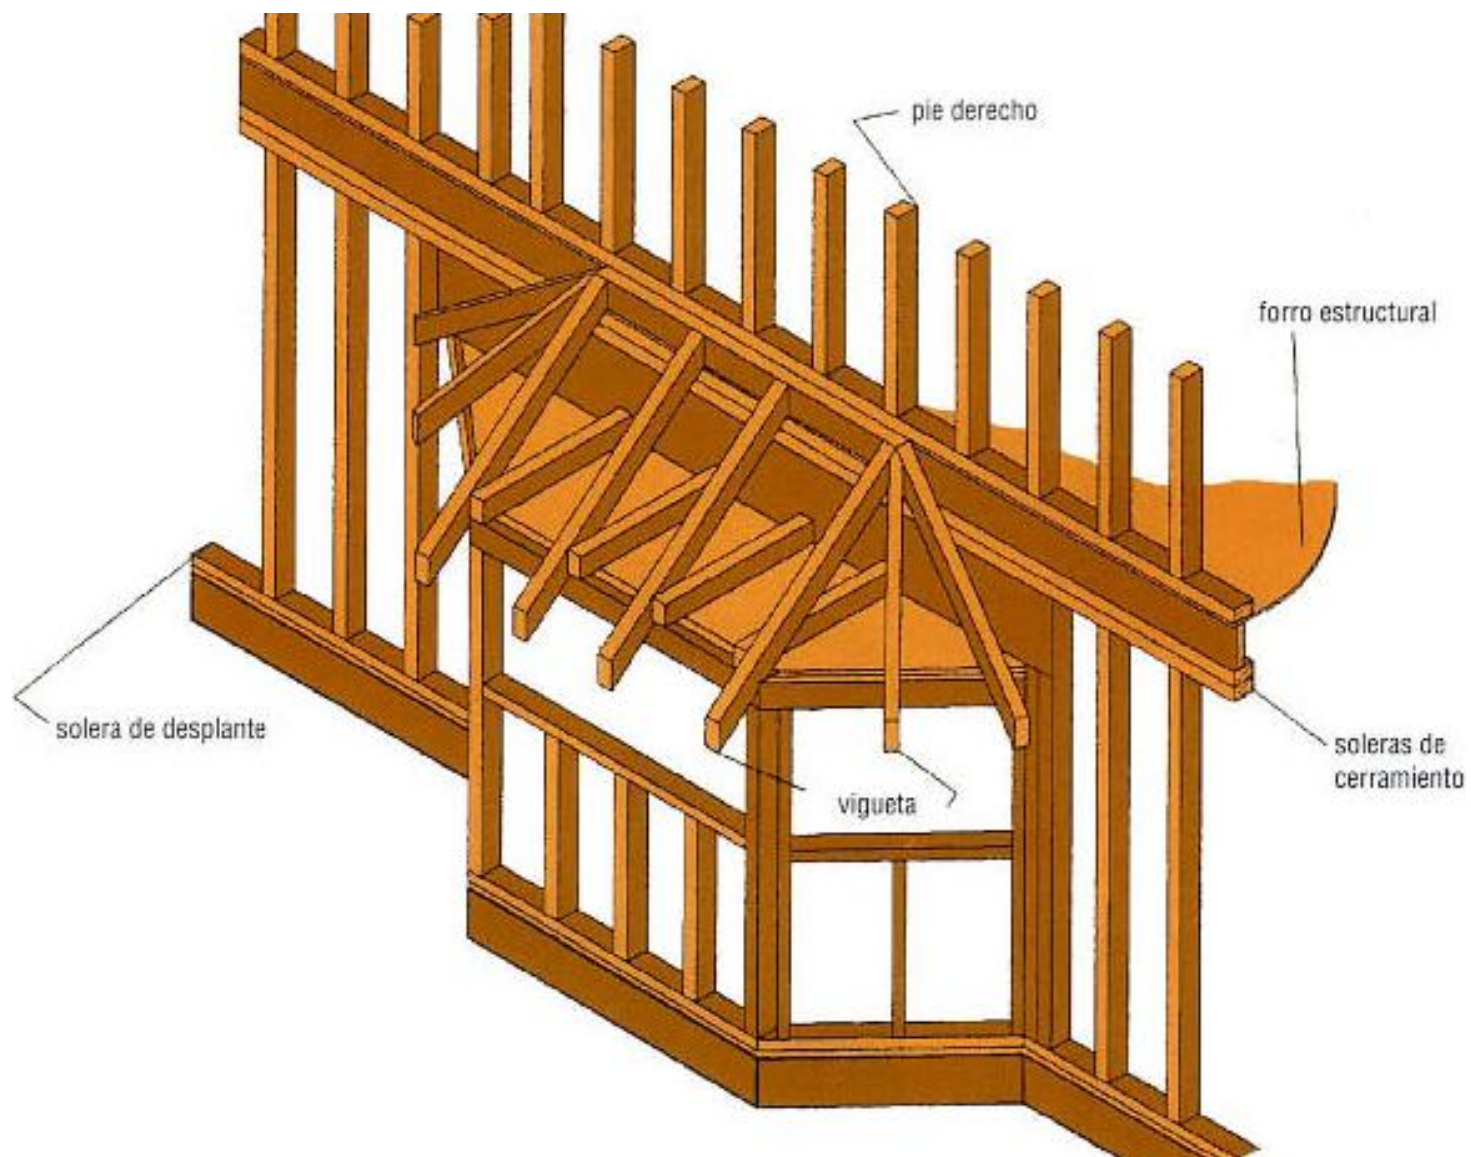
Estructuración de ventanas que sobresalen del Muro.
